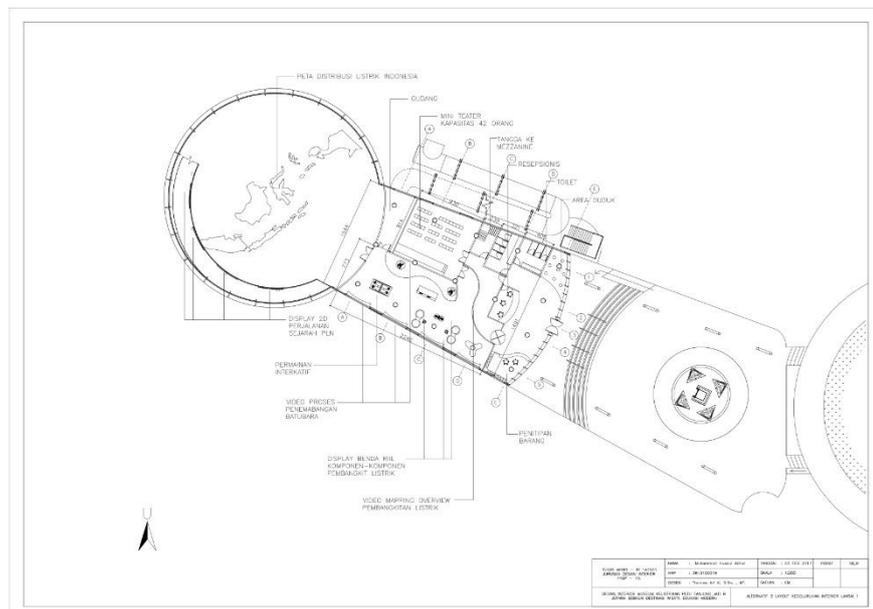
Alternatif layout 2 pada lantai 1.
